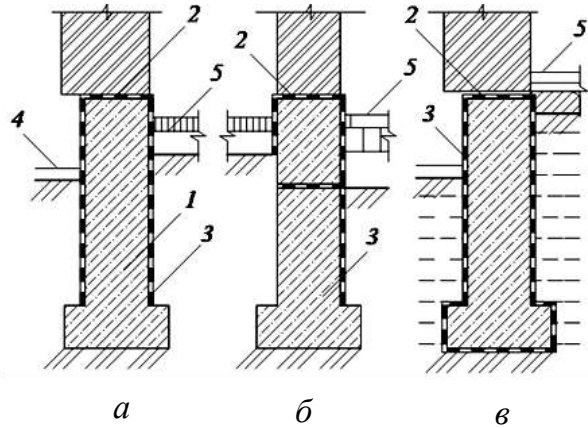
Гідроізоляція фундаментів безпідвальних будівель (підлоги по ґрунту):
